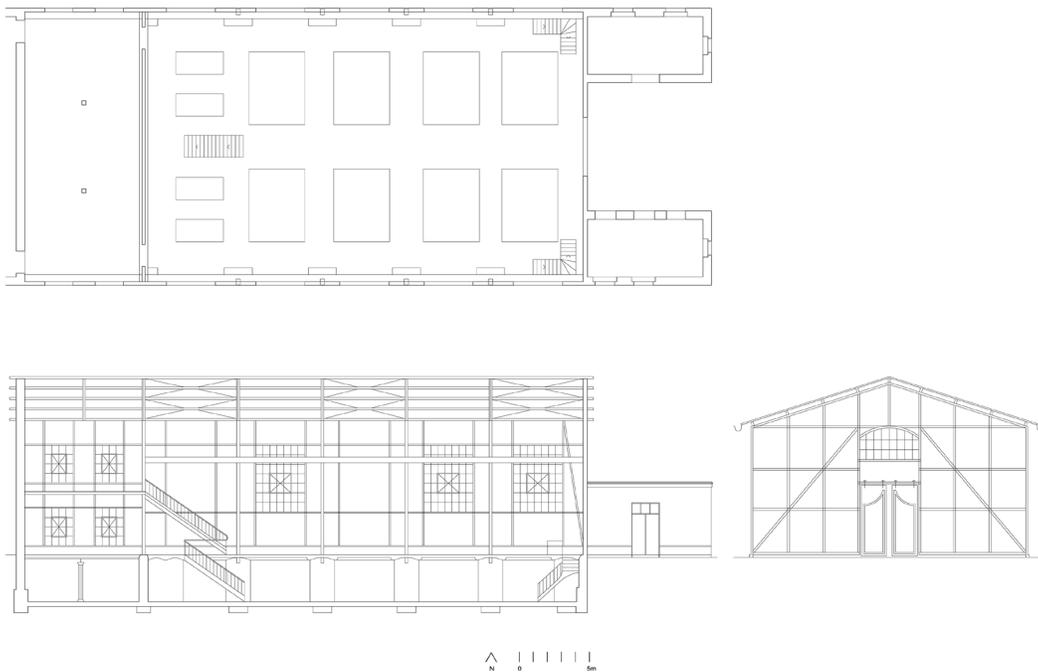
Planta, sección transversal y elevación principal del proyecto original (1908) para la subestación de calle Mapocho.
